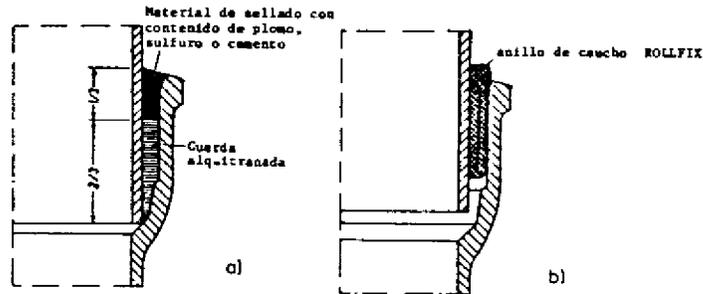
15: Empalmes para tuberías de hierro fundido
